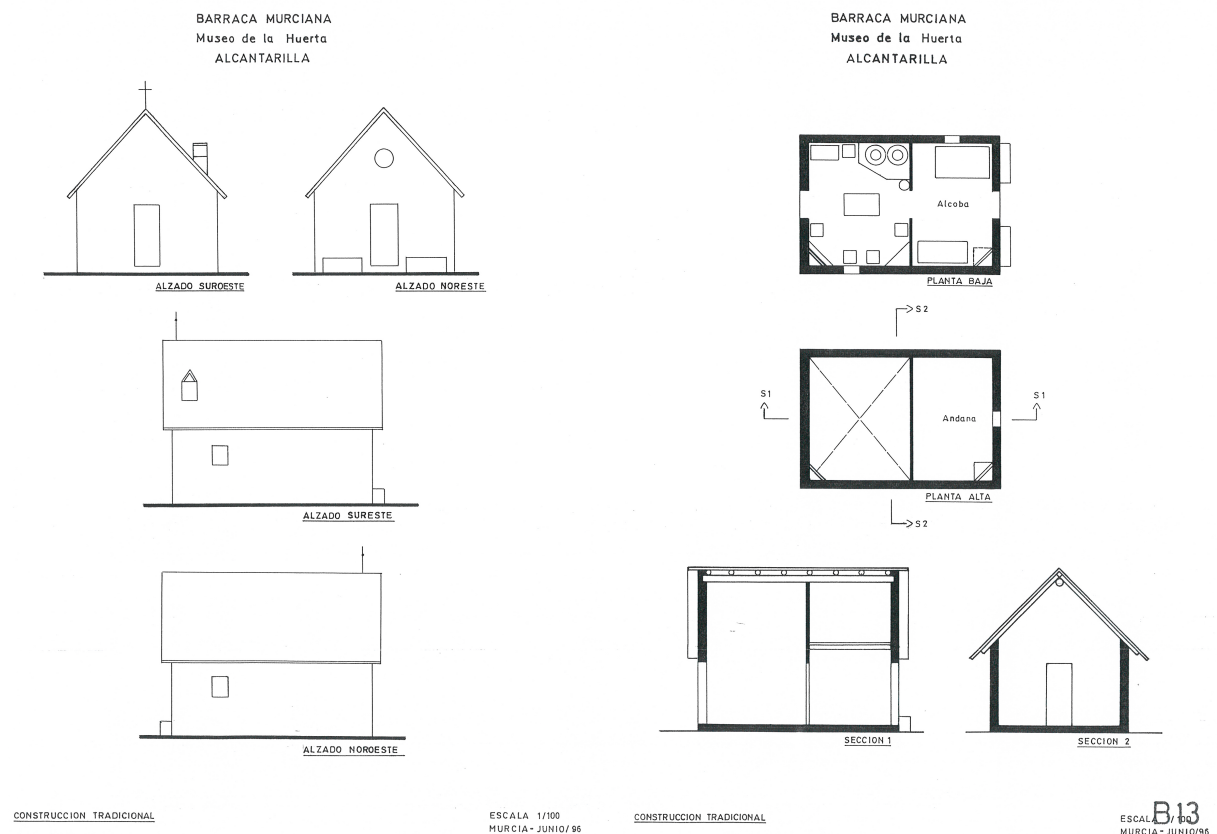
/ 13: Barraca murciana - Plantas, Alzados y Secciones
